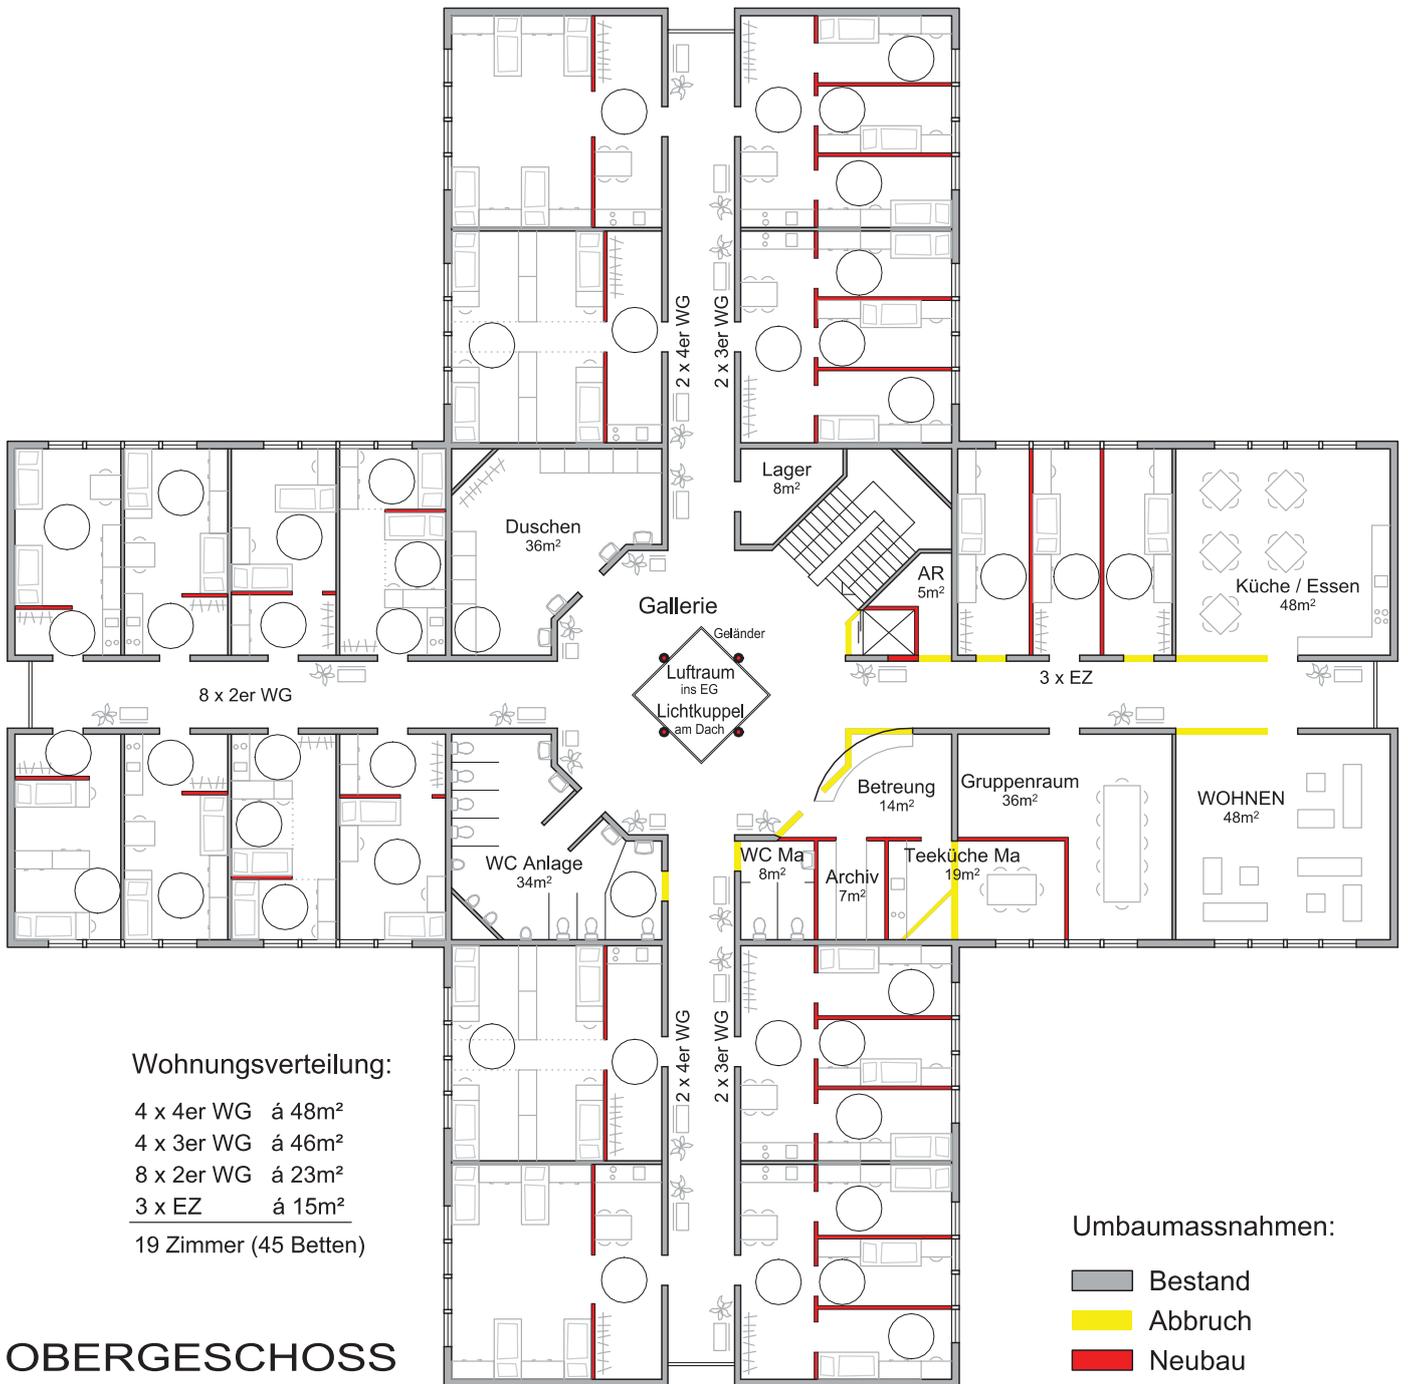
Grundriss OG - Betreute Wohngemeinschaften
